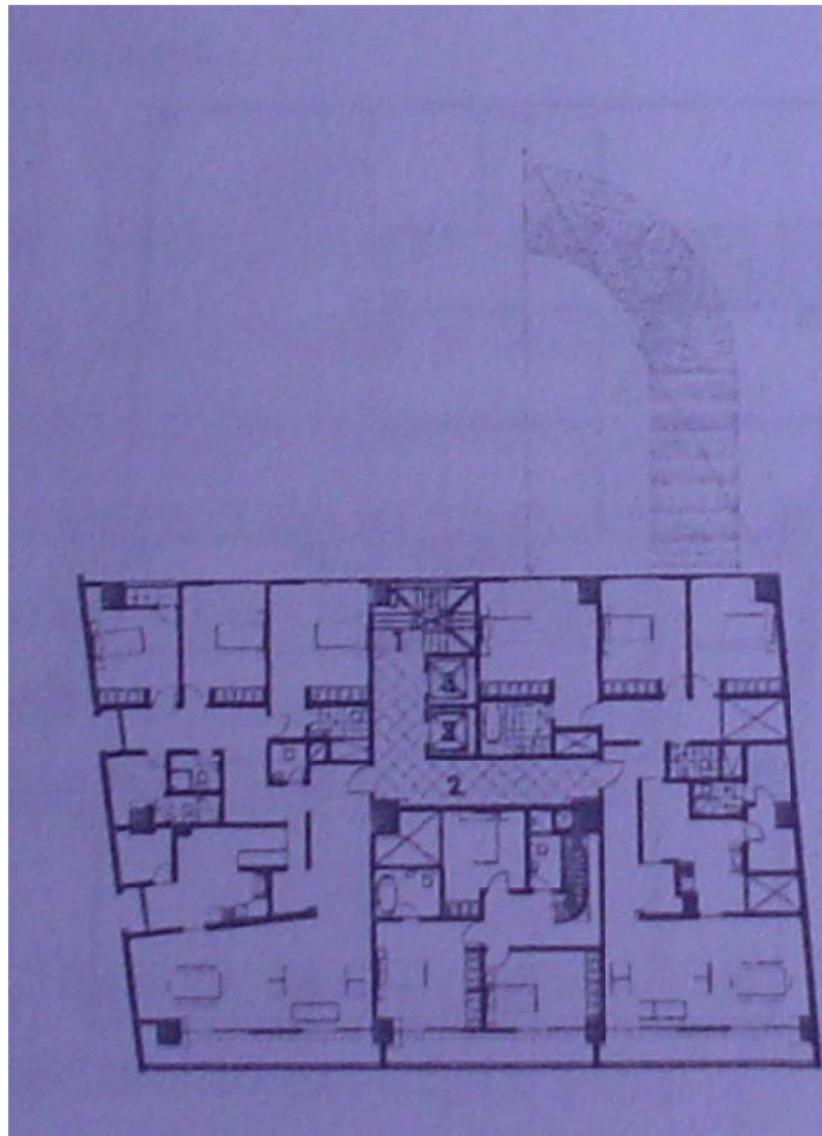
Segunda planta tipo. Fuente: Tesis Lata Guamán, Oswaldo. ALAMIRO GONZÁLEZ.
